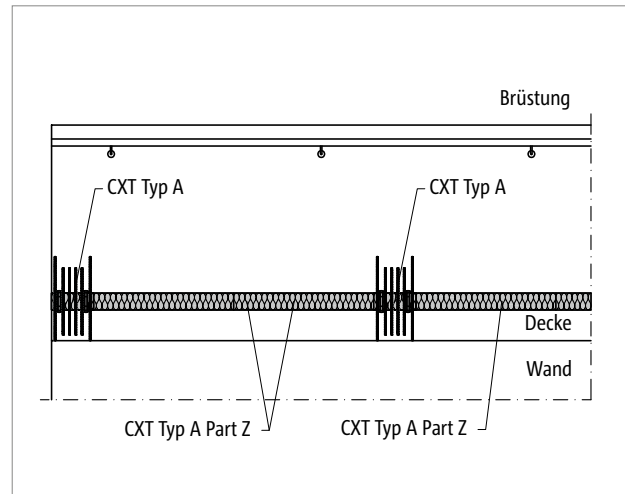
Schöck Isokorb® CXT Typ A und CXT Typ A Part Z: Brüstung
